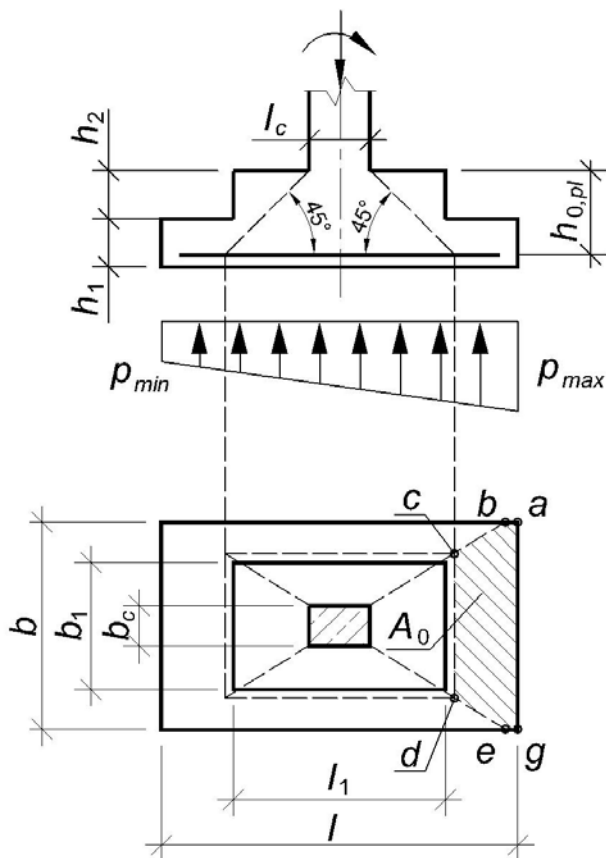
Схема образования пирамиды продавливания в центрально-нагруженных прямоугольных, а также внецентренно нагруженных квадратных и прямоугольных фундаментах
